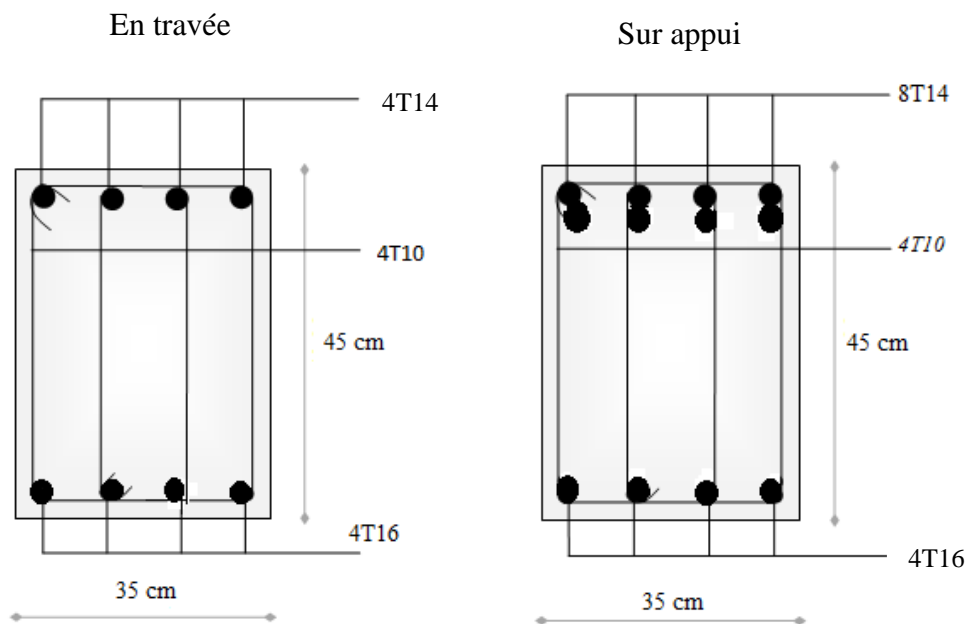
Ferrailage des poutres porteuses terrasse
